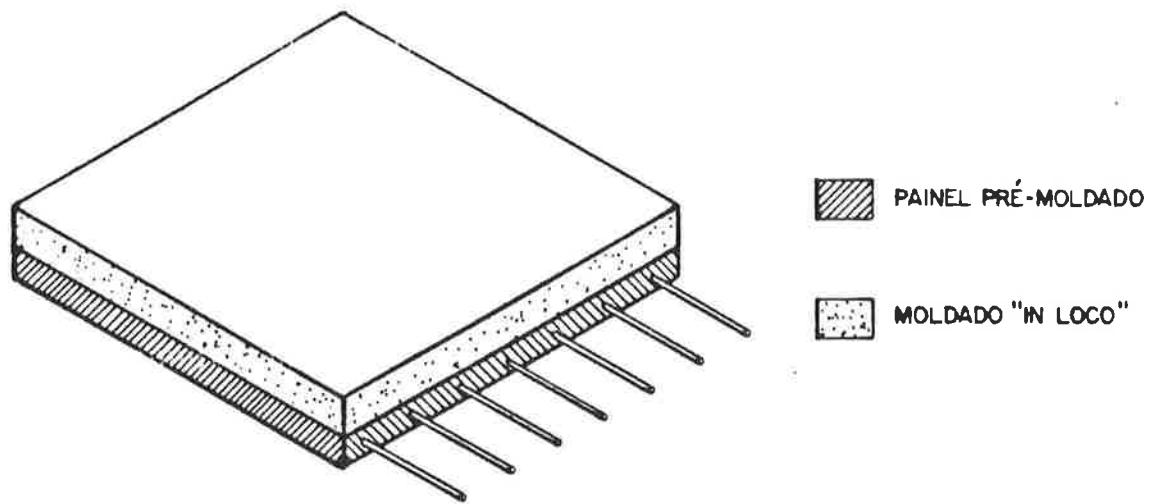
Lajes obtidas a partir de pré-lajes de concreto armado ou protendido.
